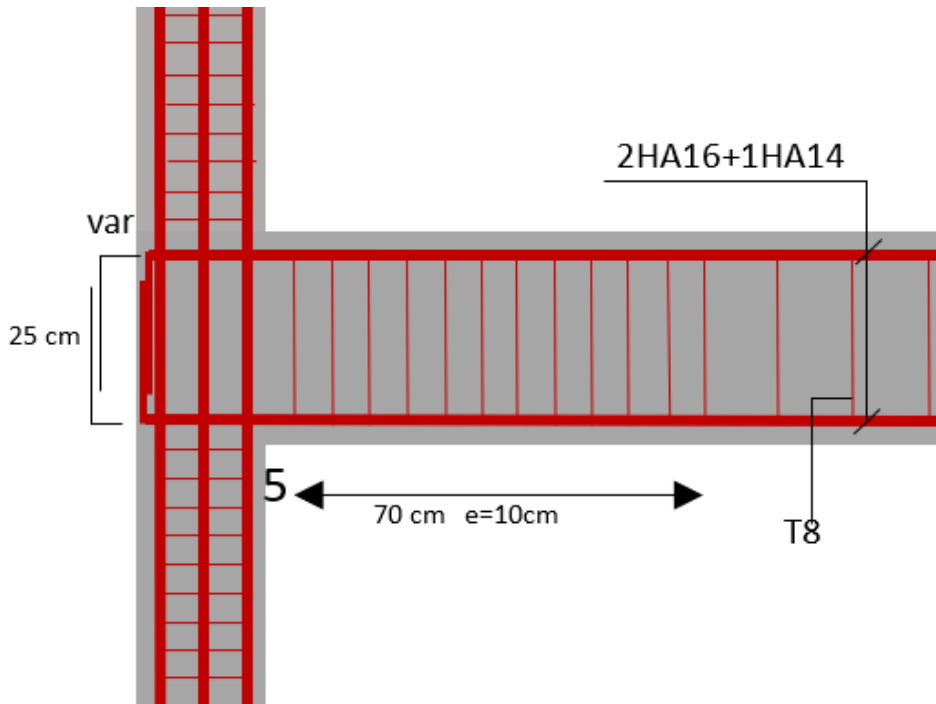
Ferrailage sur appui de rive en poutre-secondaire
